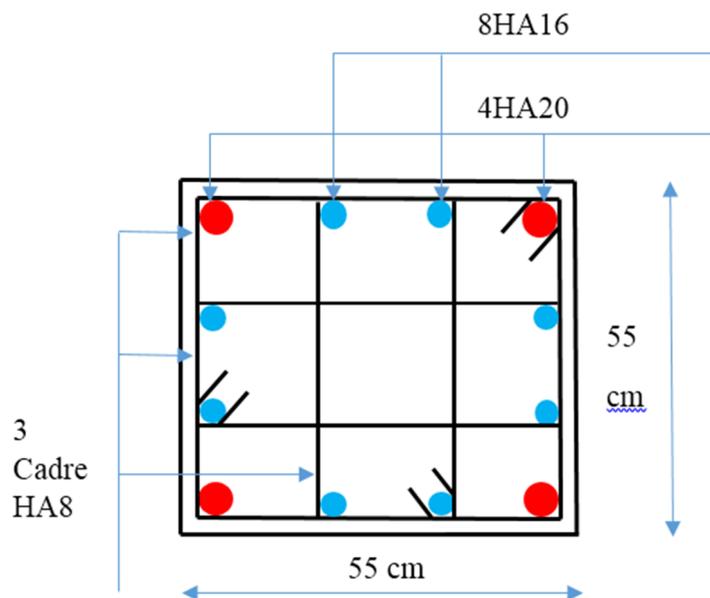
Schéma de ferrailage des poteaux (55x55)
